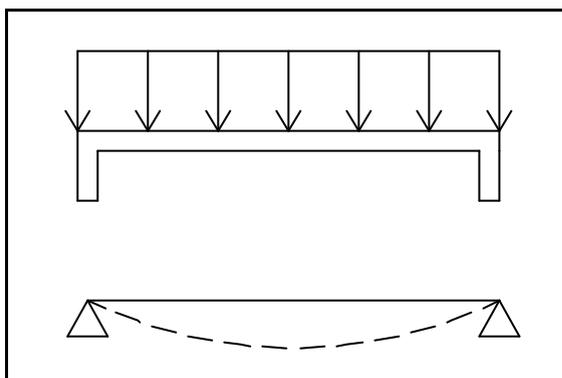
Corte de uma laje apoiada em duas vigas (Bordos apoiados)
